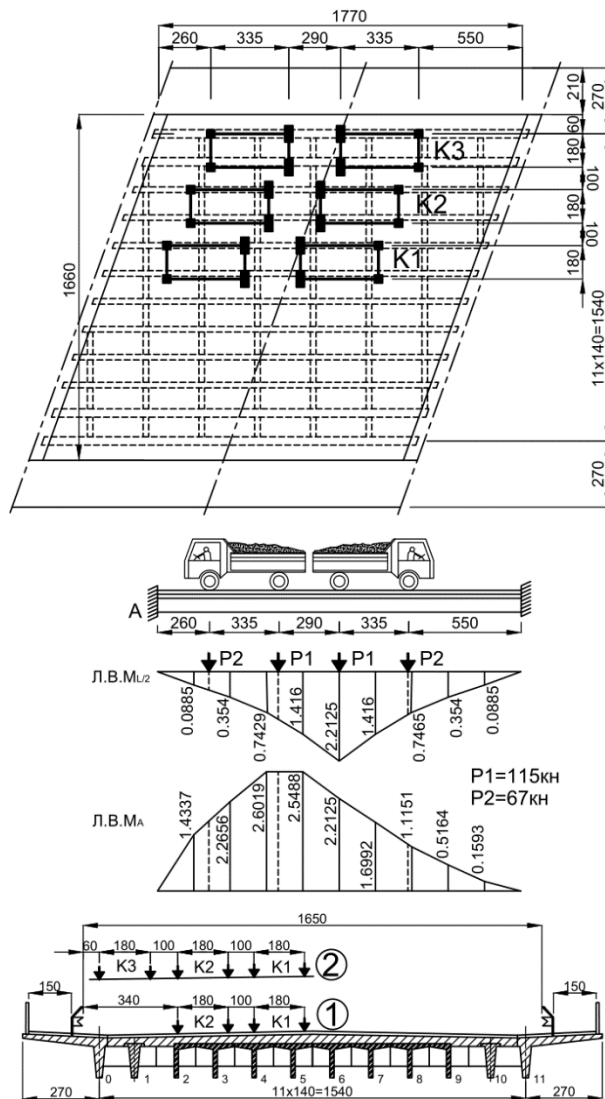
Перша (K1+K2) і друга (K1+K2+K3) схеми навантаження реконструйованої прольотної будови випробувальним навантаженням
